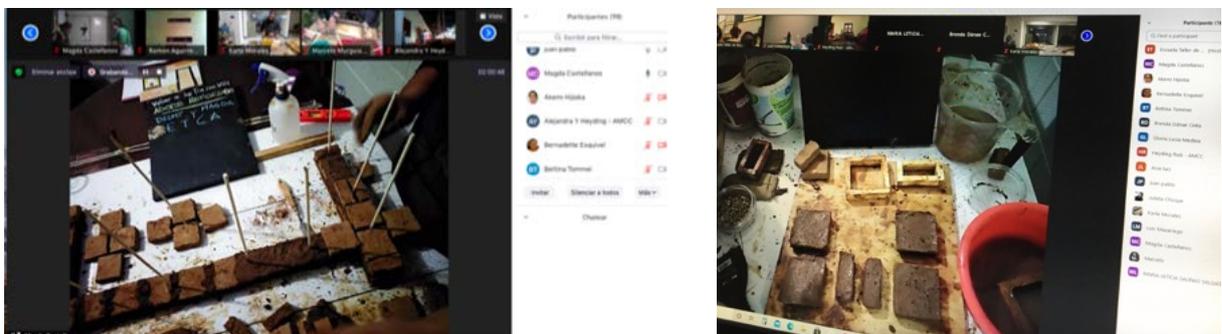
Taller virtual de “Adobe reforzado” y detalle de la elaboración de los adobes a escala
